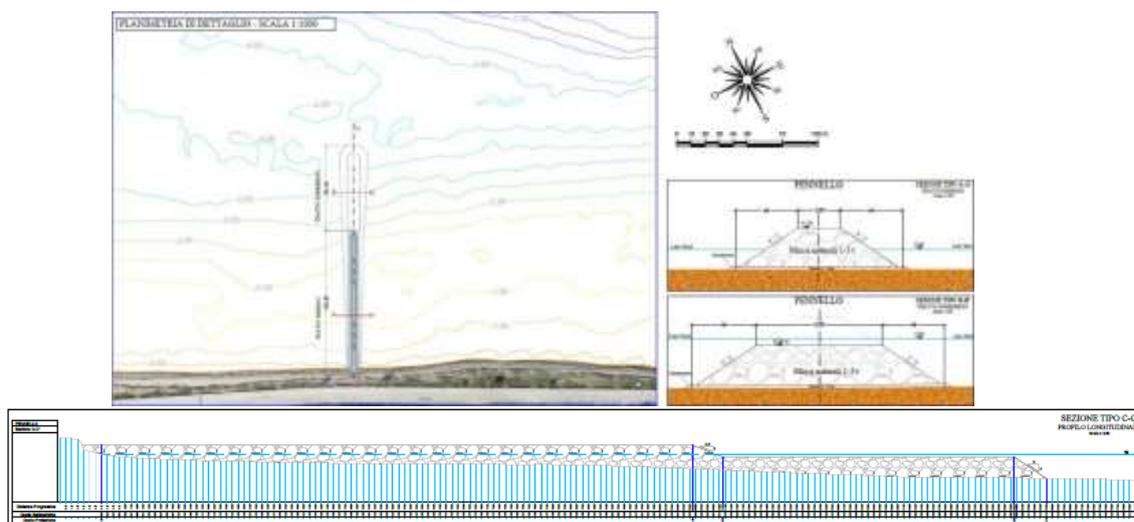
Planimetria e sezioni tipo della configurazione di progetto.
